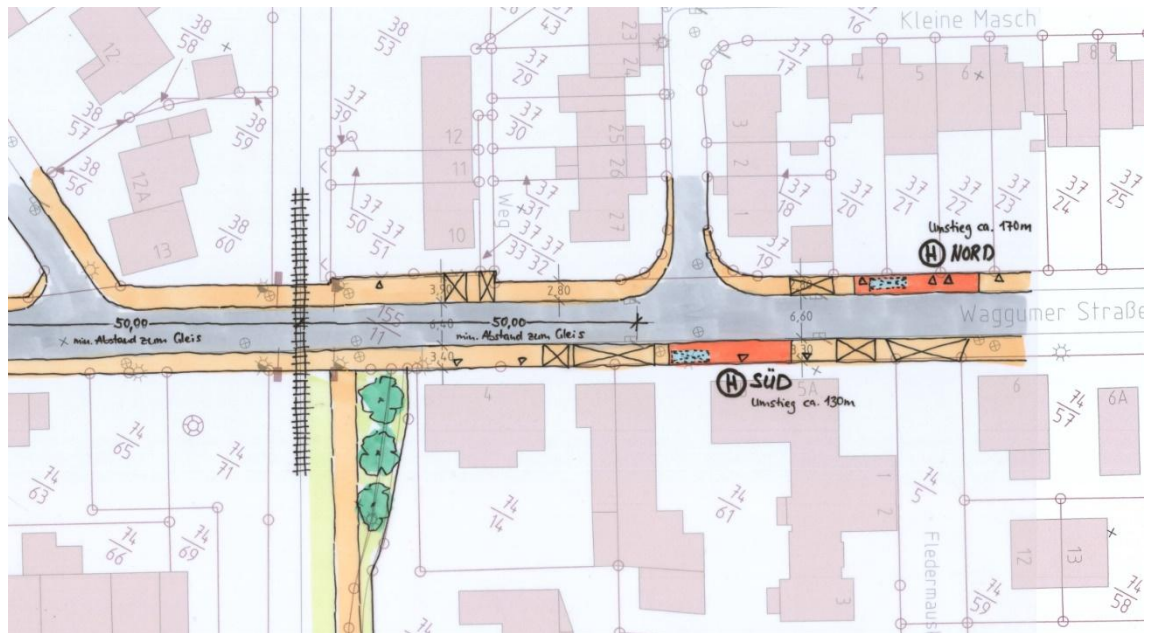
Lageplanausschnitt Haltestellen Waggumer Straße
